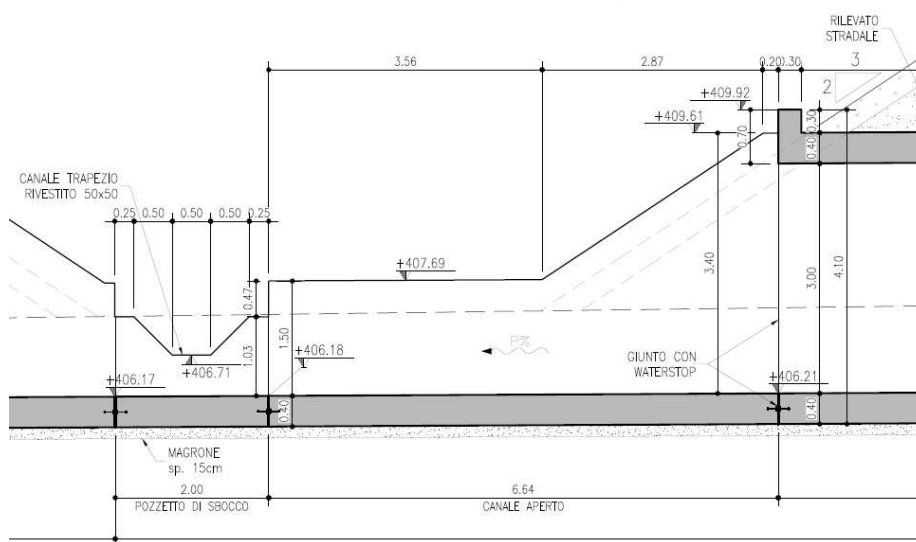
Manufatto di sbocco - Sezione longitudinale
